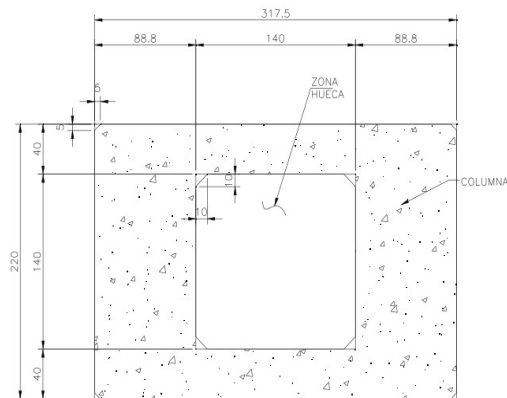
Geometría Superior de la columna (Fuente: especificaciones generales del proyecto)
